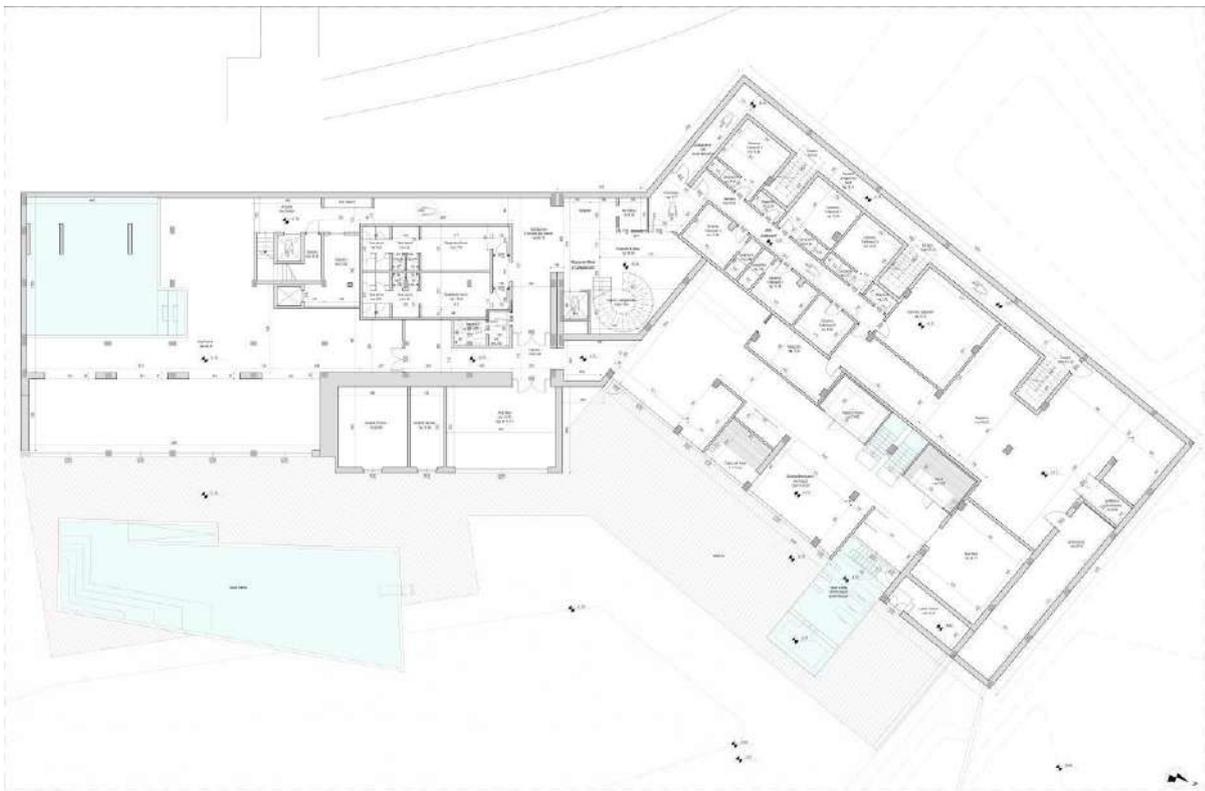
Progetto del Piano Sottostrada – Stralcio Tav. PA04
